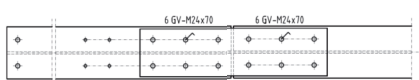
vereinfachte Schraubenbezeichnung – EMPFOHLEN!
